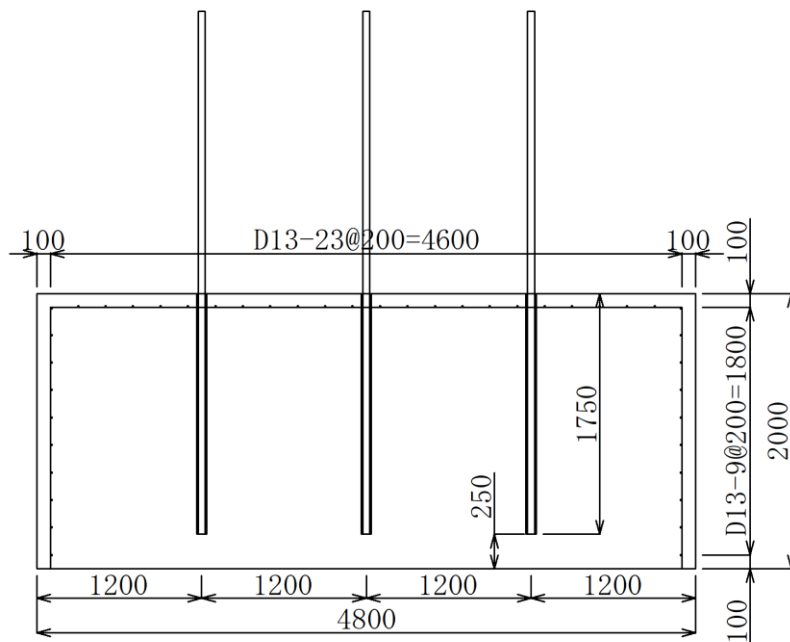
(2) 実験体①の配筋図 (A-A 断面図)
